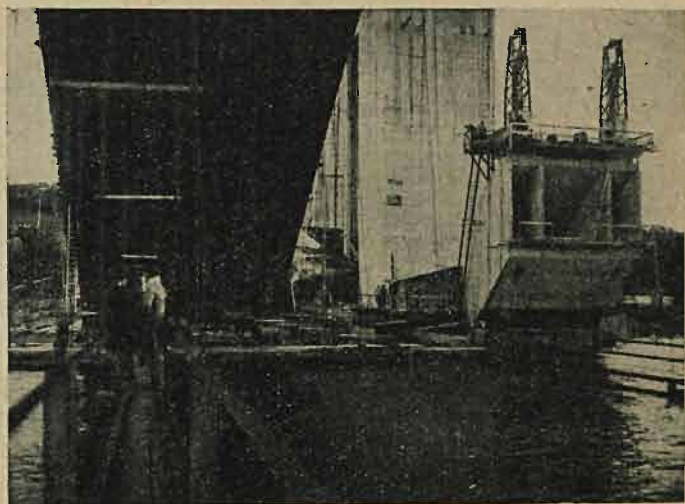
Krążyny na pontonach gotowe do przesunięcia.
